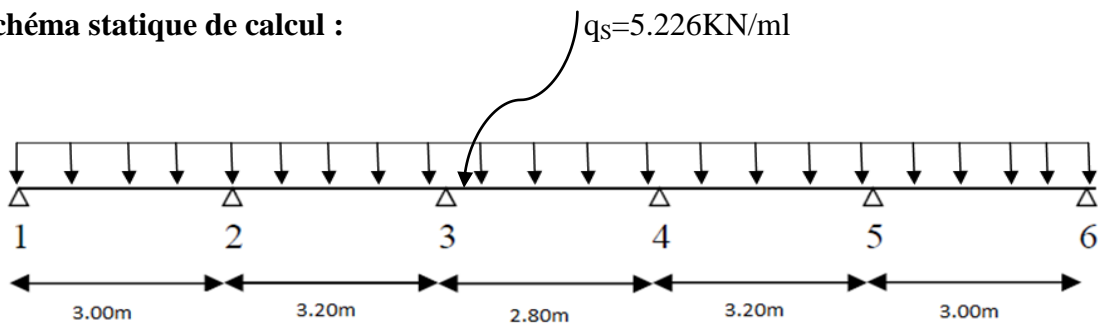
Schéma statique de la poutre continue reposant sur six appuis à L'ELS
